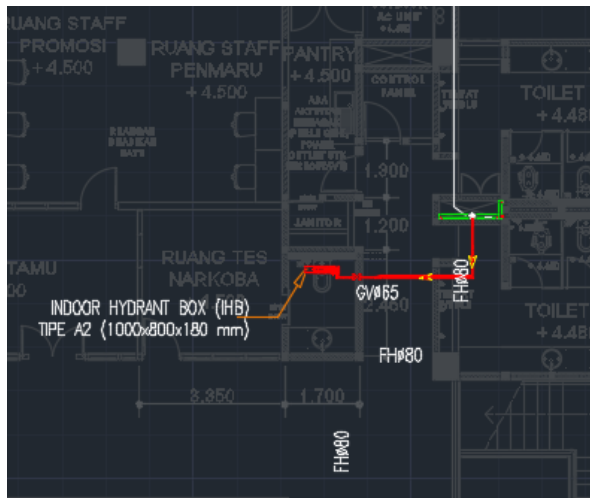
Denah Arsitektur Pemasangan IHB pada Lantai 1
